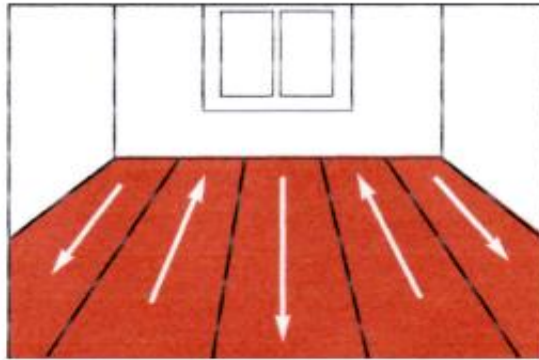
Planeamento de aplicação das folhas de vinílico [37]
